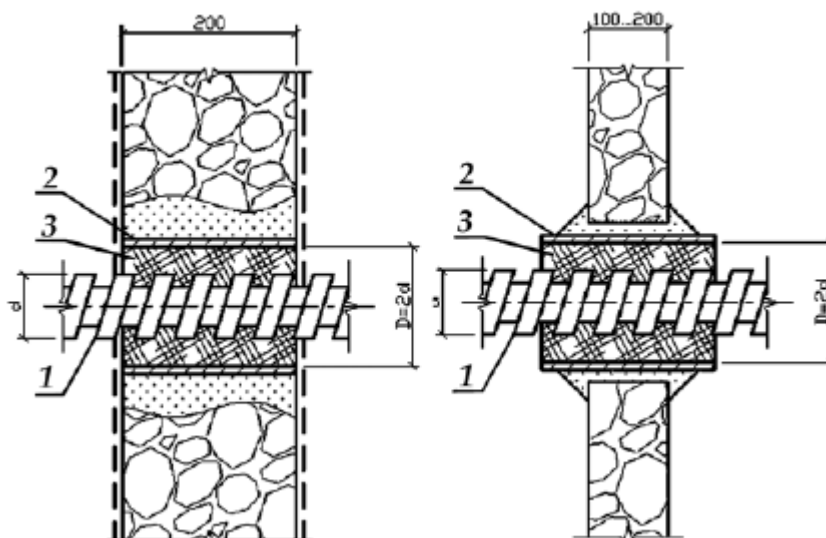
Ввод кабеля во взрывоопасное помещение через стену:
